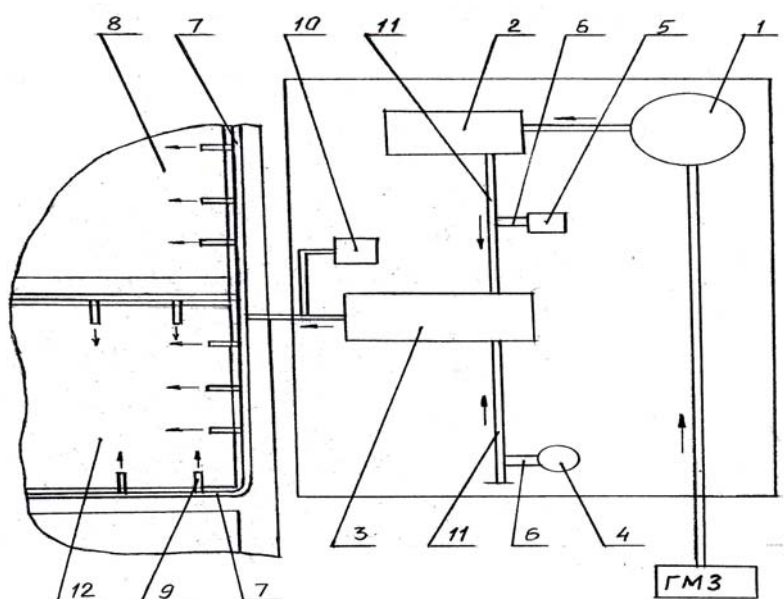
Схема раскладки бетонопровода на картах хвостохранилища
